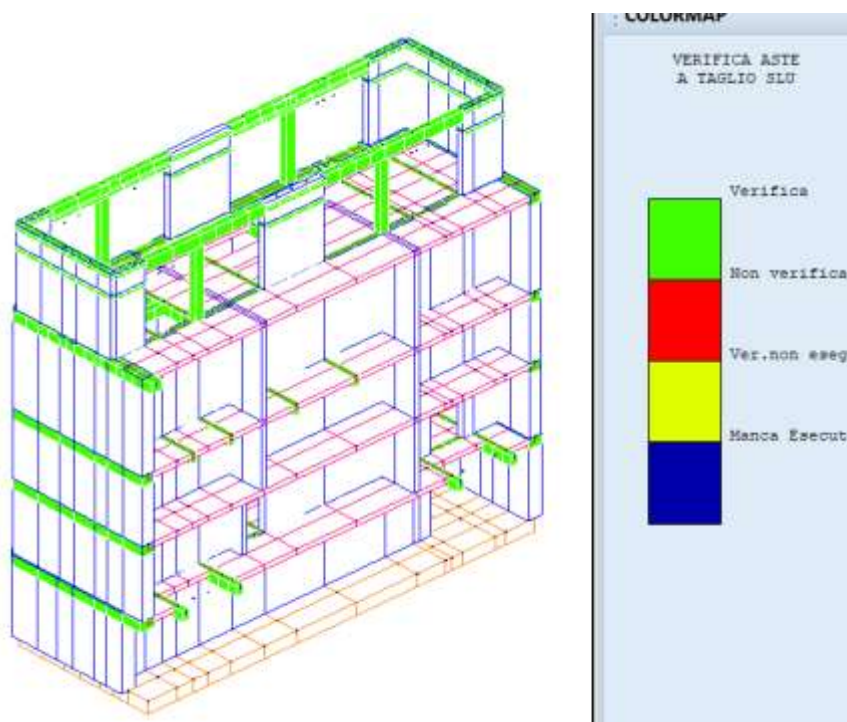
Rappresentazione verifiche a taglio SLU aste travi e pilastri
